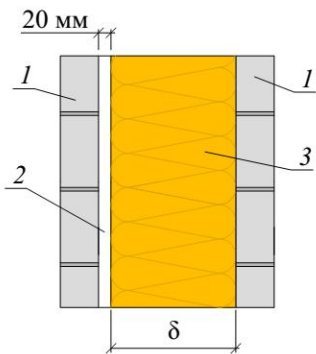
Трехслойная стена с облицовочными слоями из кирпича: 1 – слой в полкирпича; 2 – 20 мм вентилируемого слоя; 3 – тепловая изоляция
